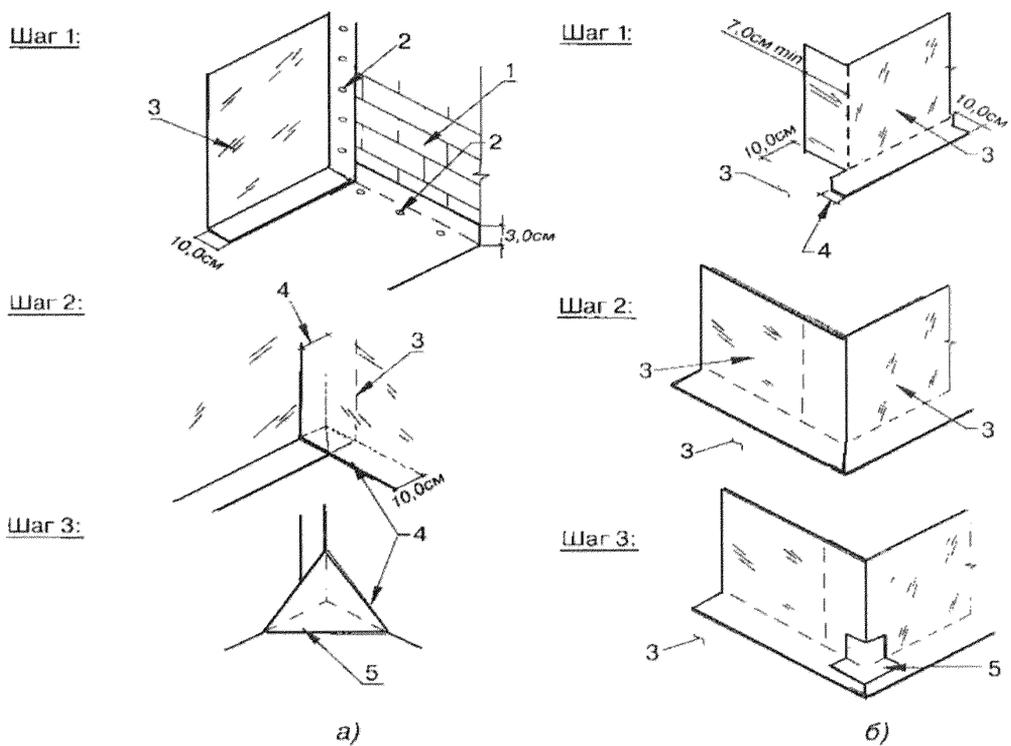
Устройство кровли во внутреннем углу парапета или стены (а)
